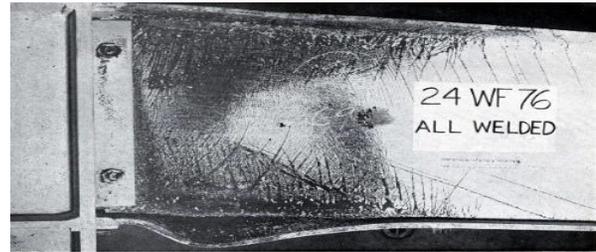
Ejemplos de daños en columna y en viga de pórticos de acero.
